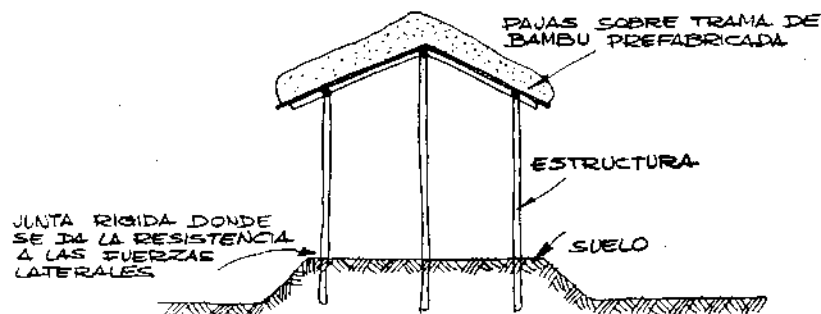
Estructura de la casa de las islas Fiji sin armazones de sostén.
